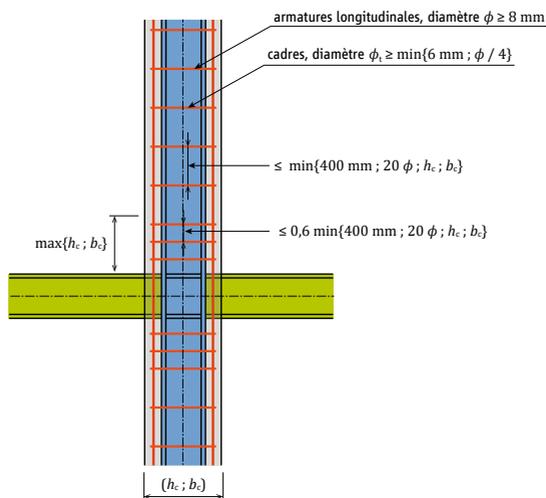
Disposition des armatures d'un poteau mixte totalement enrobé
